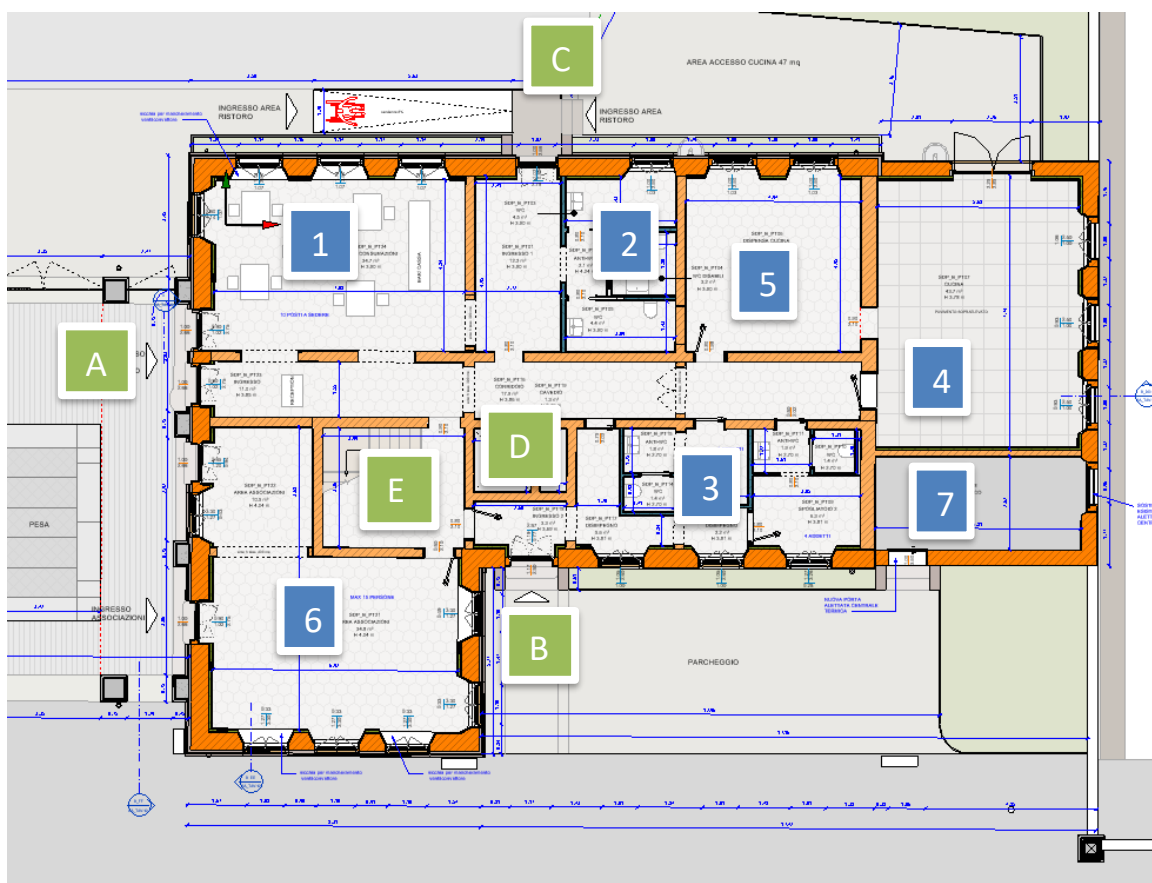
Estratto tavola di progetto – Edificio B pianta piano terra.
